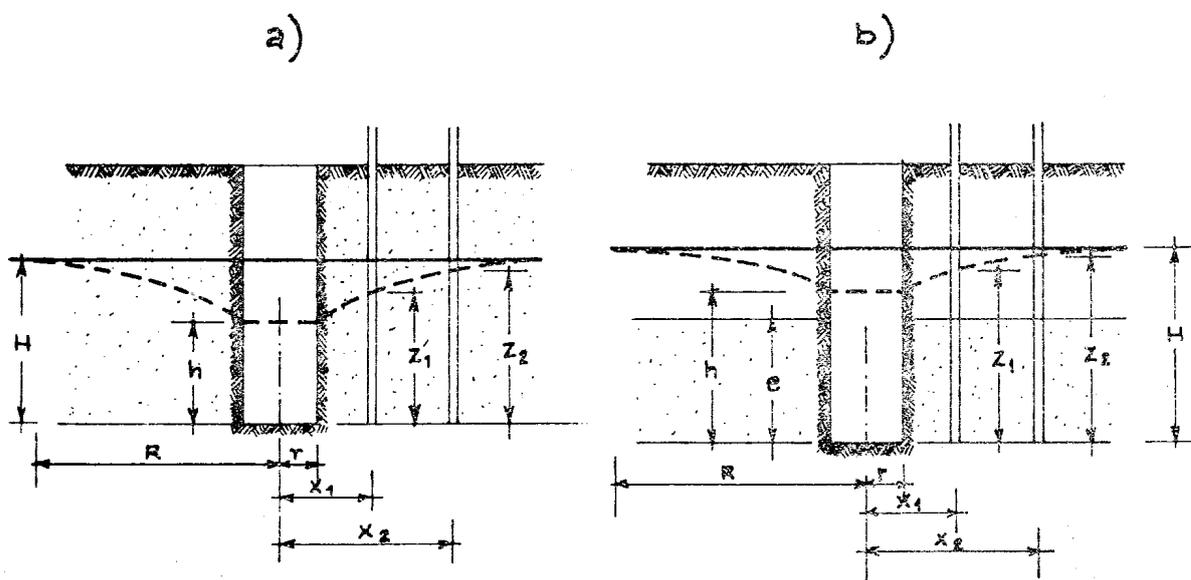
SCHEMA DI PROVE DI EMUNGIMENTO IN PERFORAZIONE DI SONDAGGIO (CON 2 PIEZOMETRI DI MISURA); a) FALDA A PELO LIBERO b) FALDA IN PRESSIONE.
